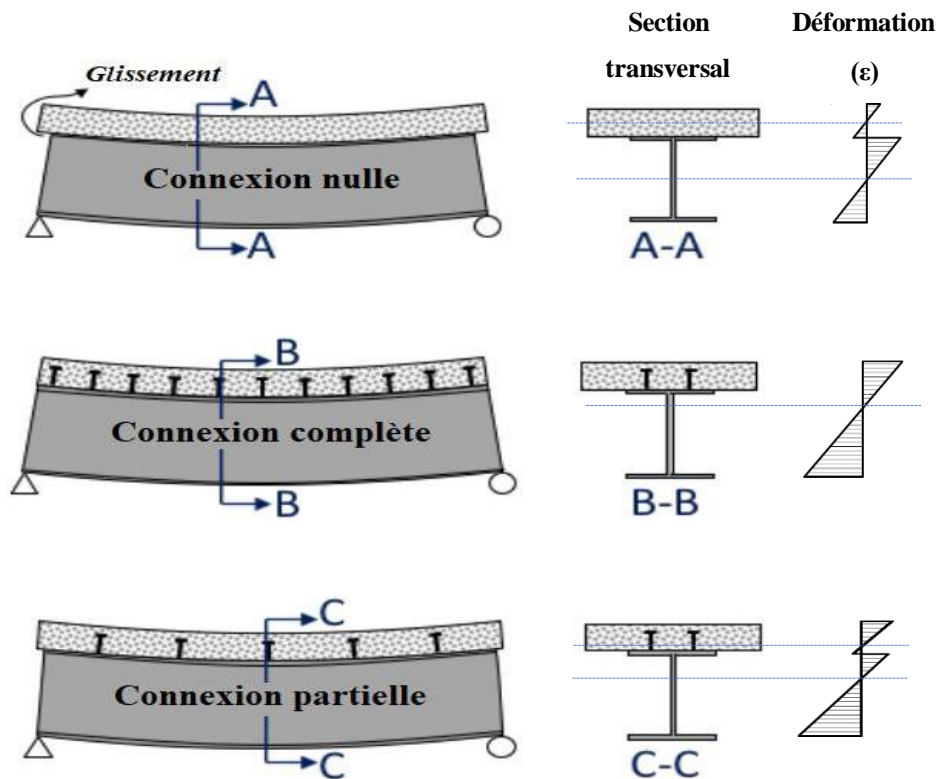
Type de connexion à l'interface de la poutre mixte
